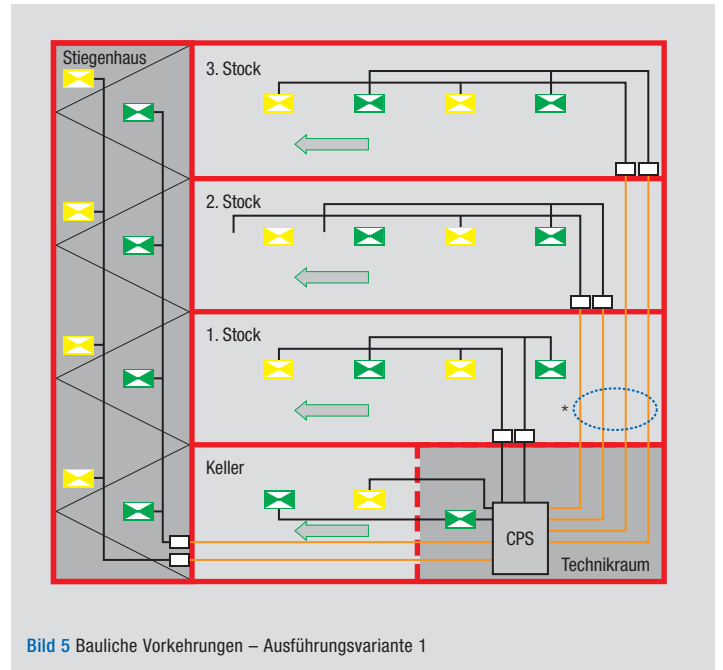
Bauliche Vorkehrungen – Ausführungsvariante 1
